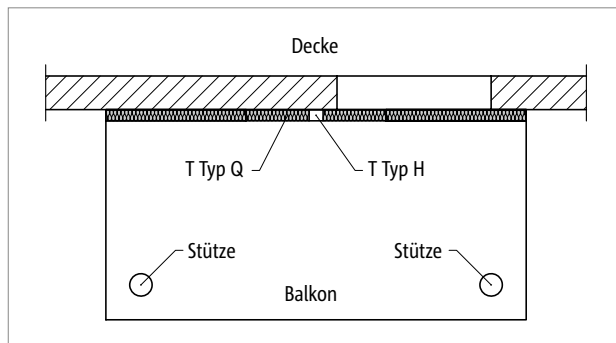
Schöck Isokorb® T Typ Q: Balkon mit Stützenlagerung
